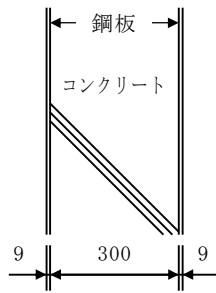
遮蔽扉の概要 (単位 : mm)
